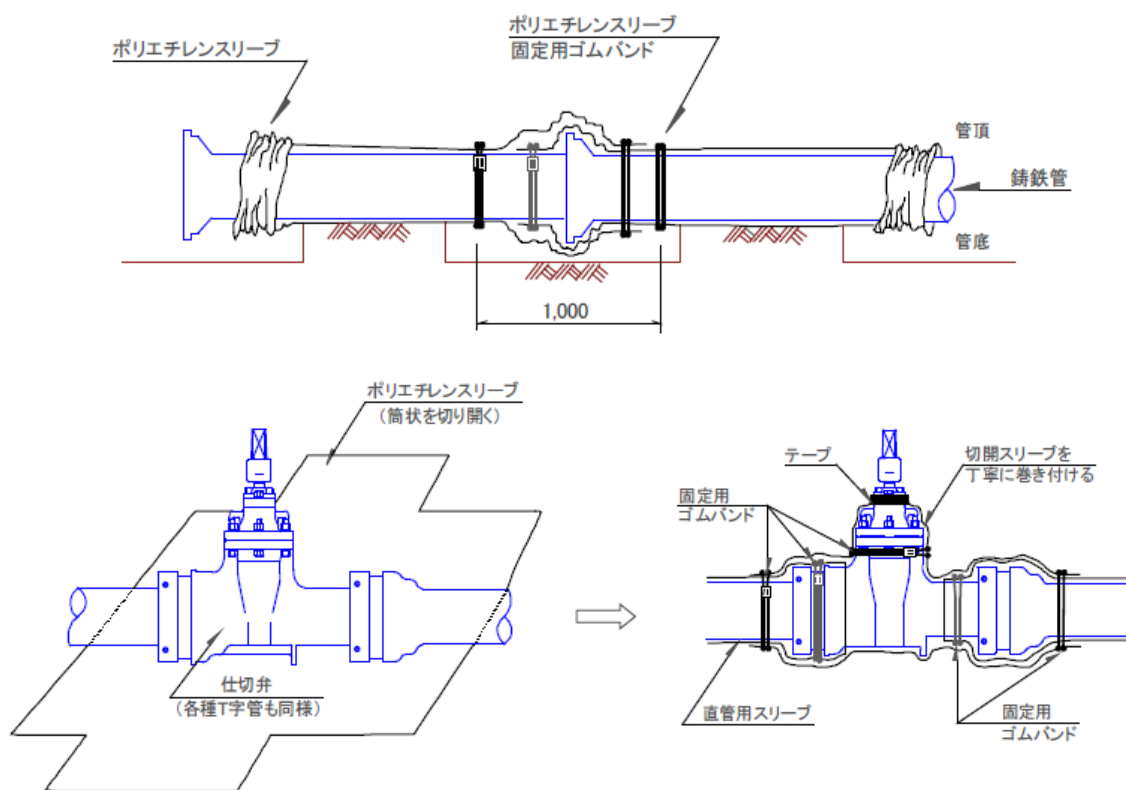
ダクタイル鋳鉄管用ポリエチレンシート被覆参考施工図
